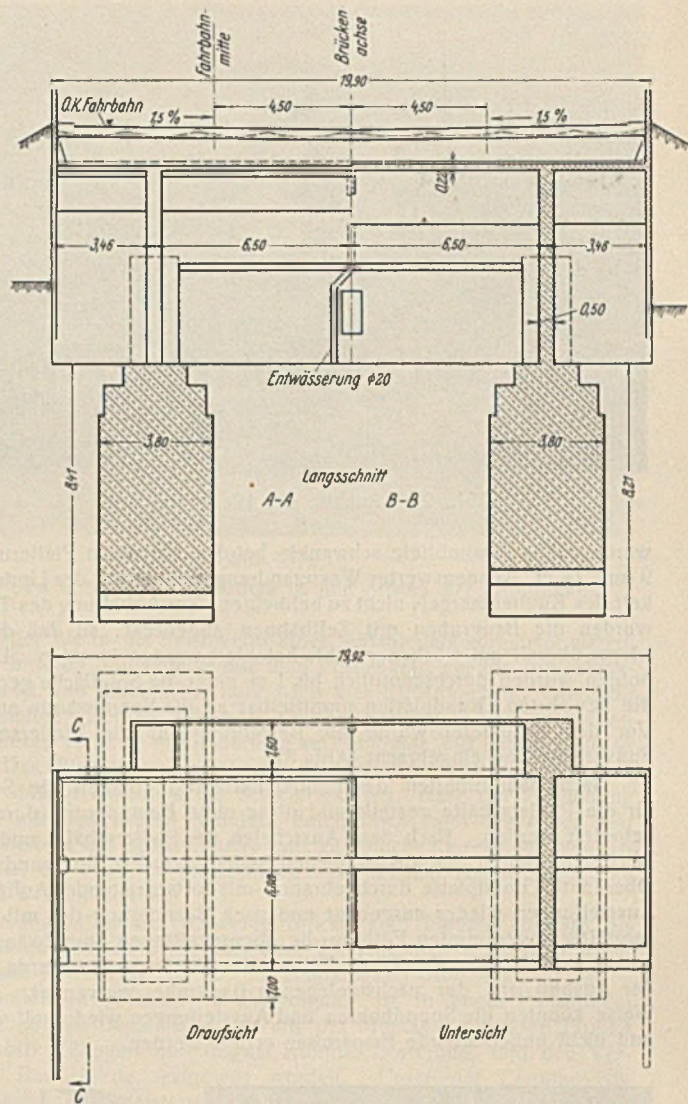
Widerlager (Richtung Ulm) am beweglichen Lager.
